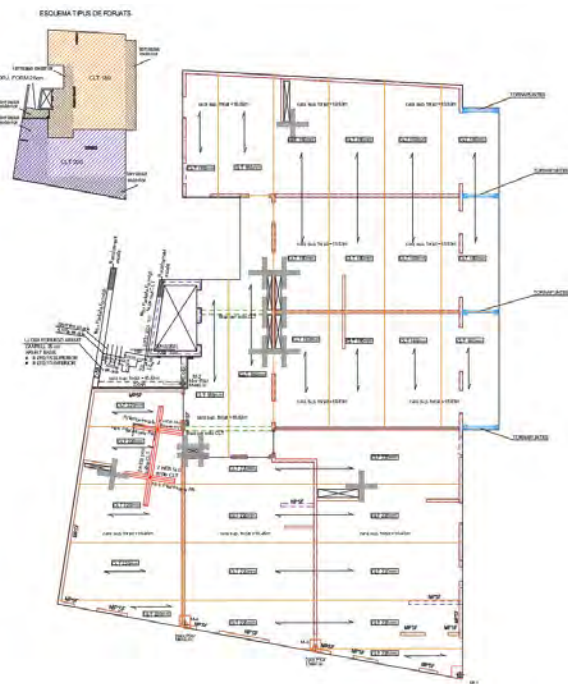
Representació en planta de la divisió dels panells, segons el projecte d'estructures.
